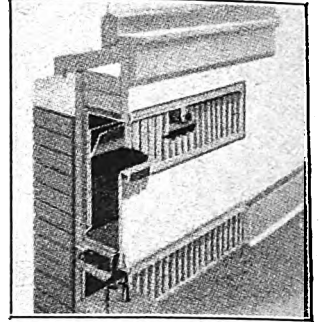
Gasofen in die Fenster-Brüstung eingebaut.
